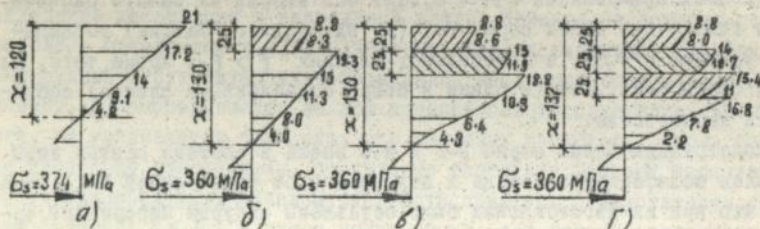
Эпюры напряжений в сжатых зонах бетона и растянутой арматуре опытных балок при $\eta = 0,9$.
